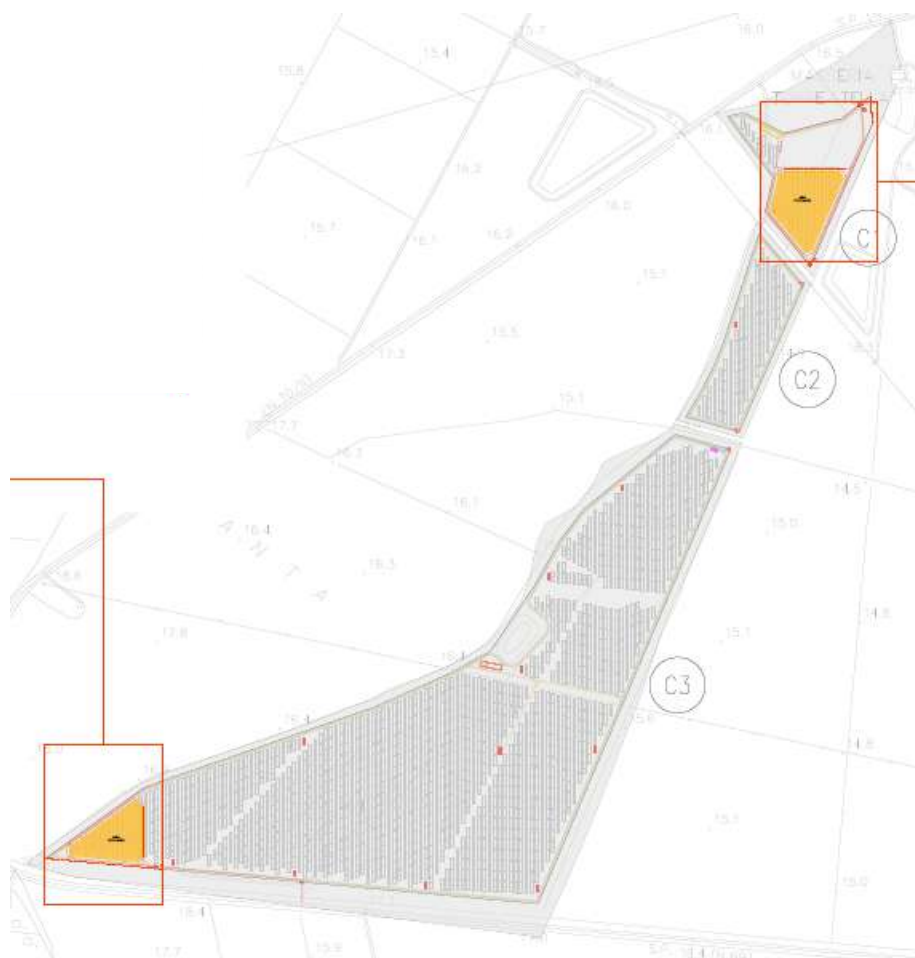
Localizzazione e struttura delle aree di cantiere (Rif. 2800_5152_SIGON_PD_R01_T08_Rev0_PLANIMETRIA CANTIERE).
